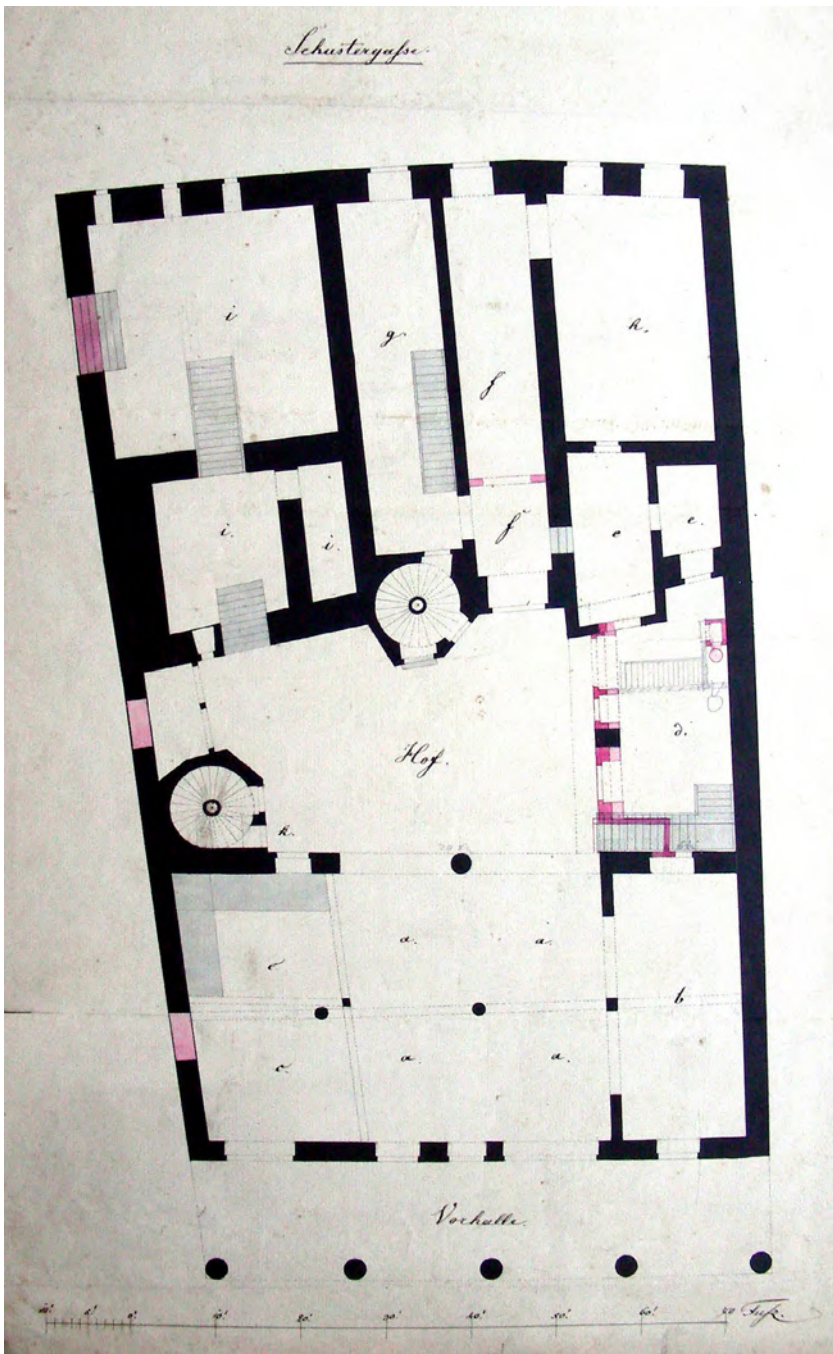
Untergeschoss-Grundriss des „Historischen Kaufhauses“, Haus C mit gewölbtem Vorkeller, Treppenhaus und Tiefkeller („i“, links oben) sowie spätere Durchgänge zum Salzhaus. Plan: Mitte 19. Jahrhundert, Münsterbauhütte Freiburg.
